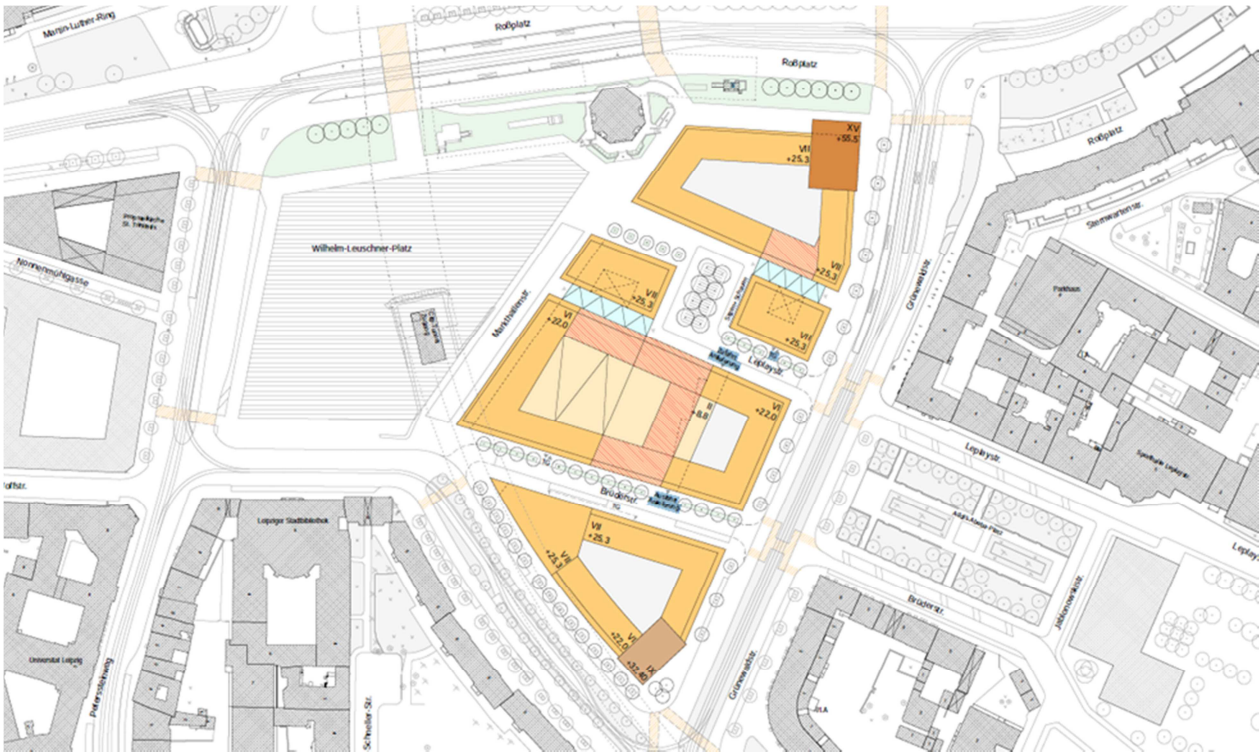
Lageplan • Übersicht Quelle: Masterplanung PWB Pelčák & Wolf Architekten und GRUNWALD & GRUNWALD
